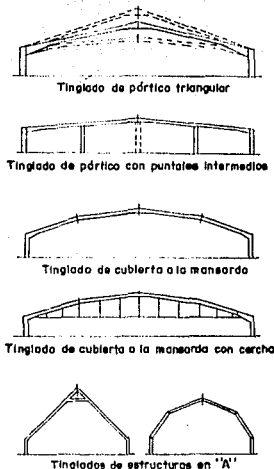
TIPOS DE CONSTRUCCION DE TINGLADOS DE TRANSITO
